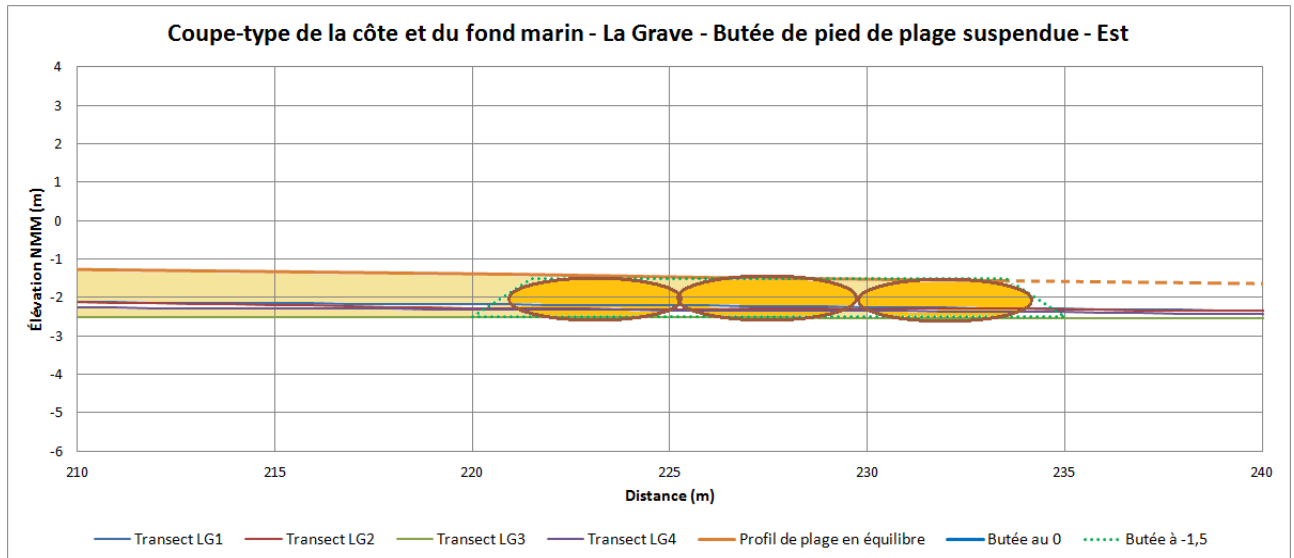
Coupe type d'une butée de pied de plage suspendue en géotubes à -1,5 m NMM
